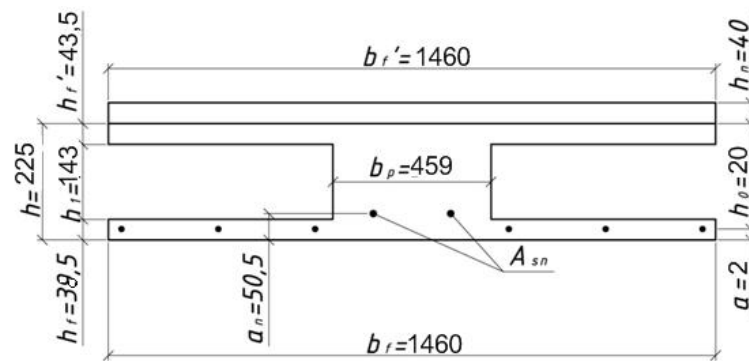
Розрахунковий переріз плити з врахуванням бетону нарощування
